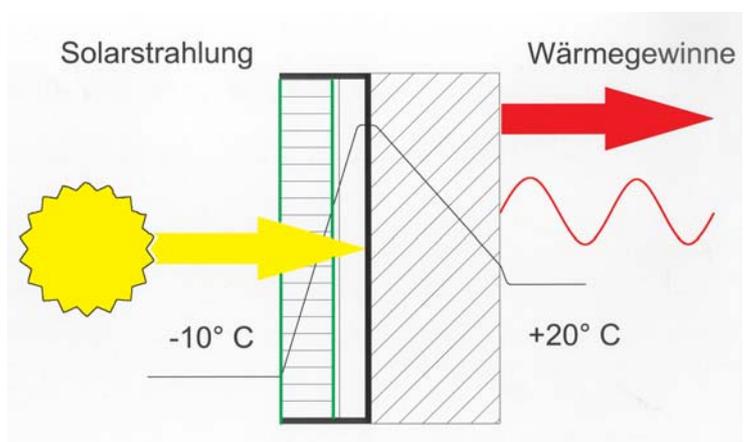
Eine Fassade mit transparenter Wärmedämmung als Strahlungsheizkörper
